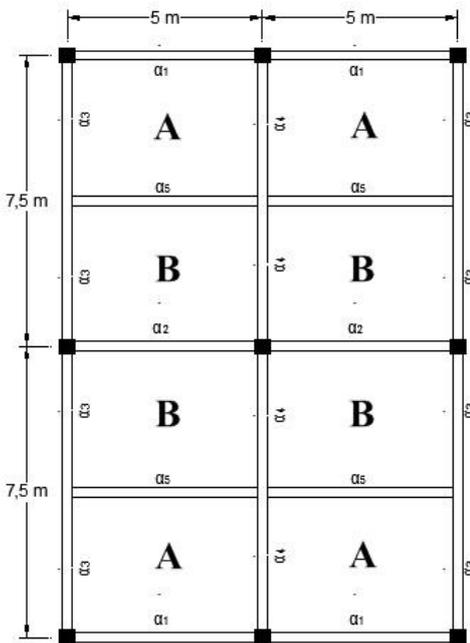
Denah Model Struktur Tipe A2 (dengan satu balok anak)
